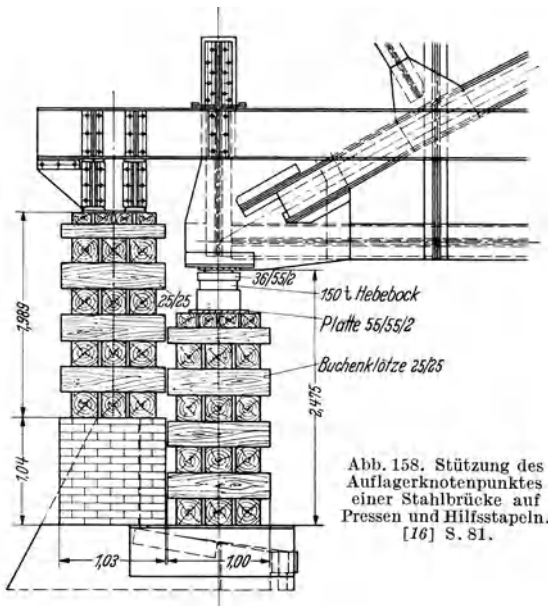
Stützung des Auflagerknotenpunktes einer Stahlbrücke auf Pressen und Hilfsstapeln. [16] S. 81.
